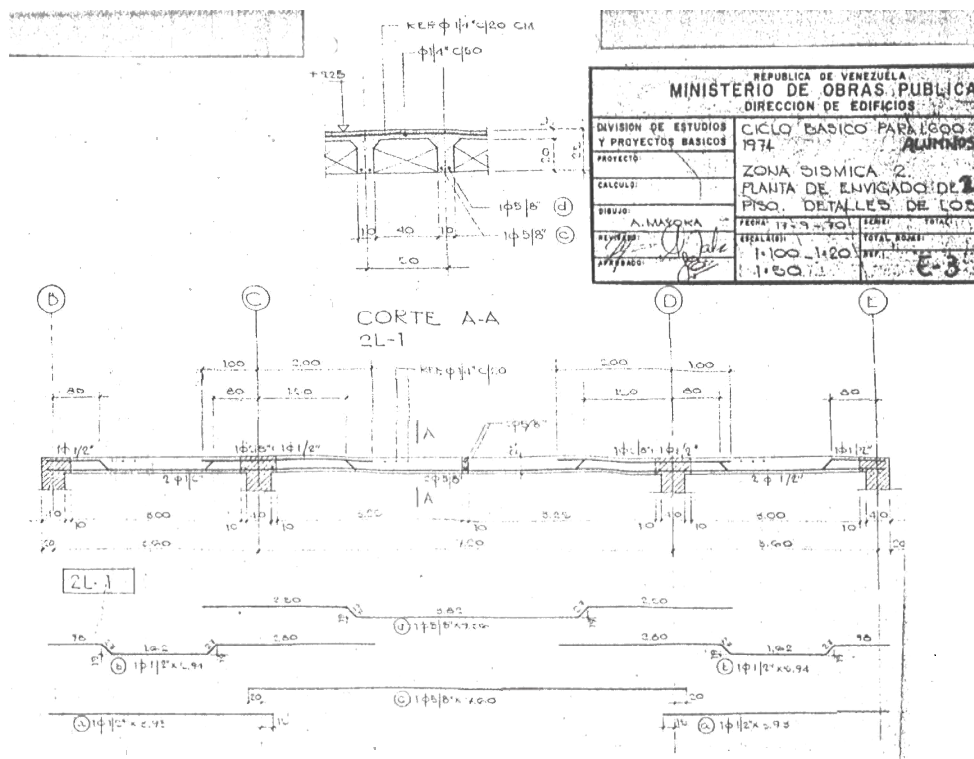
Planta de envigado de 2 Pisos. Tipo Cajetón
